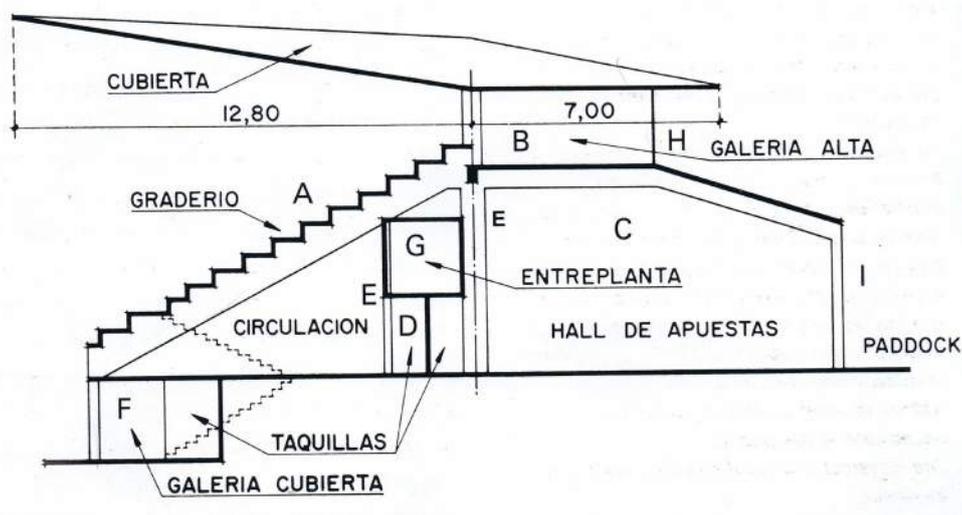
PRIMERA PROPUESTA DE ESTRUCTURA
